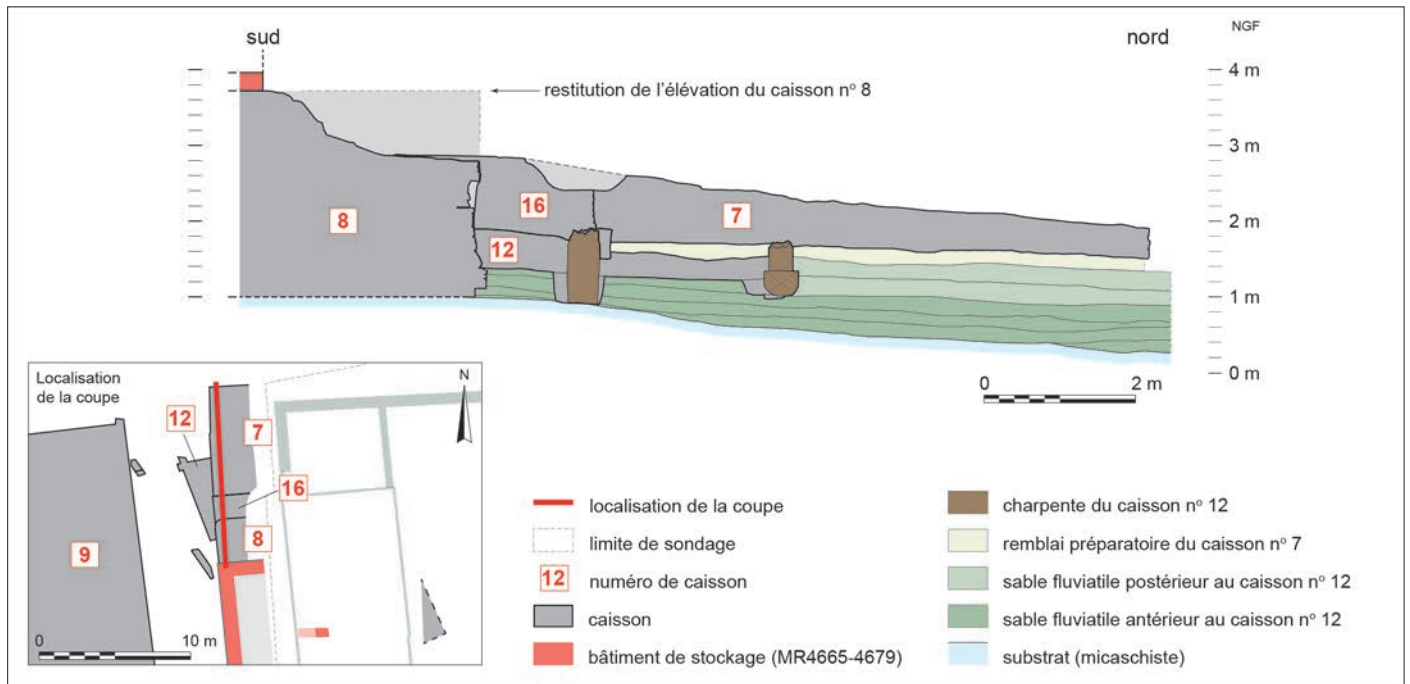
Coupe longitudinale des caissons n°s 12, 8, 16 et 7 et restitution de l'élévation du caisson n° 8 (DAO : X. Favreau).
